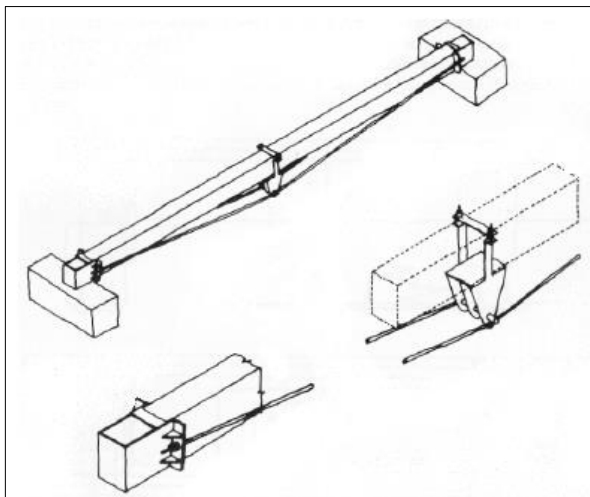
Reforço de peças de madeira com aplicação de tirantes pré-esforçados
